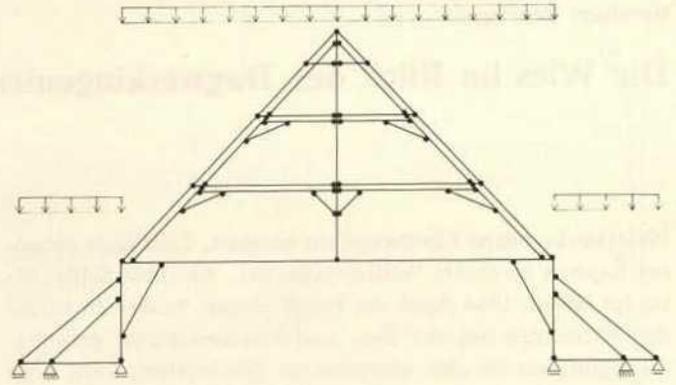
Stabwerksystem Dachstuhl, vertikale Last
